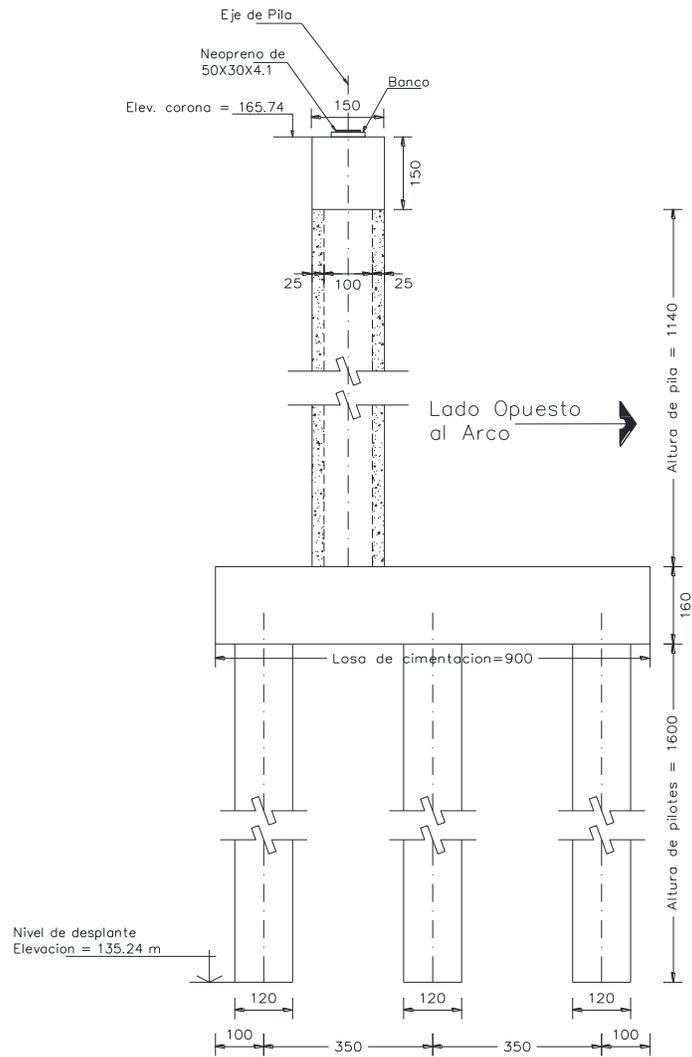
Vista Longitudinal de pilas No. 2 y 3.
